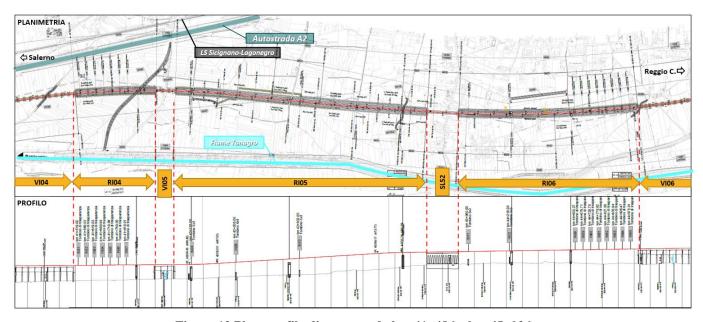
Planoprofilo di progetto da km 41+486 a km 45+026
